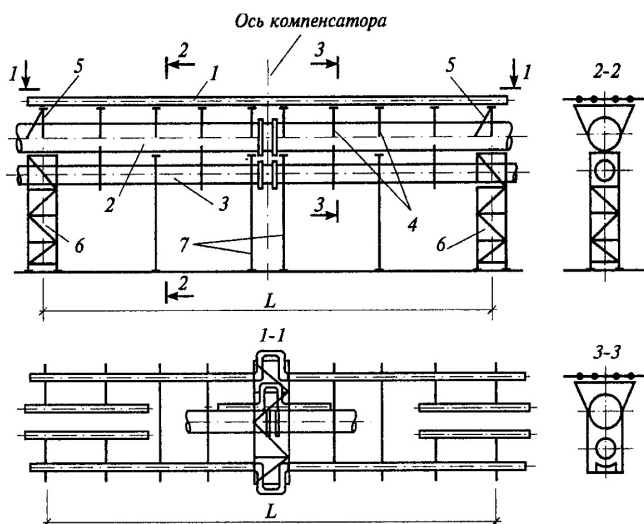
Конструктивная схема при поперечном сечении типа I:
